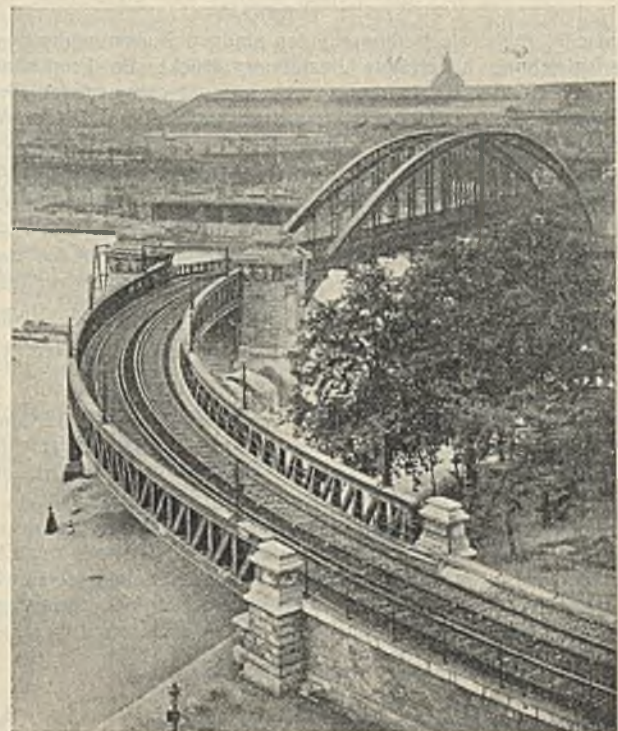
Zufahrtbrücke über den Hafen Rapée-Bercy bei der Austerlitzbrücke über die Seine in Paris.
